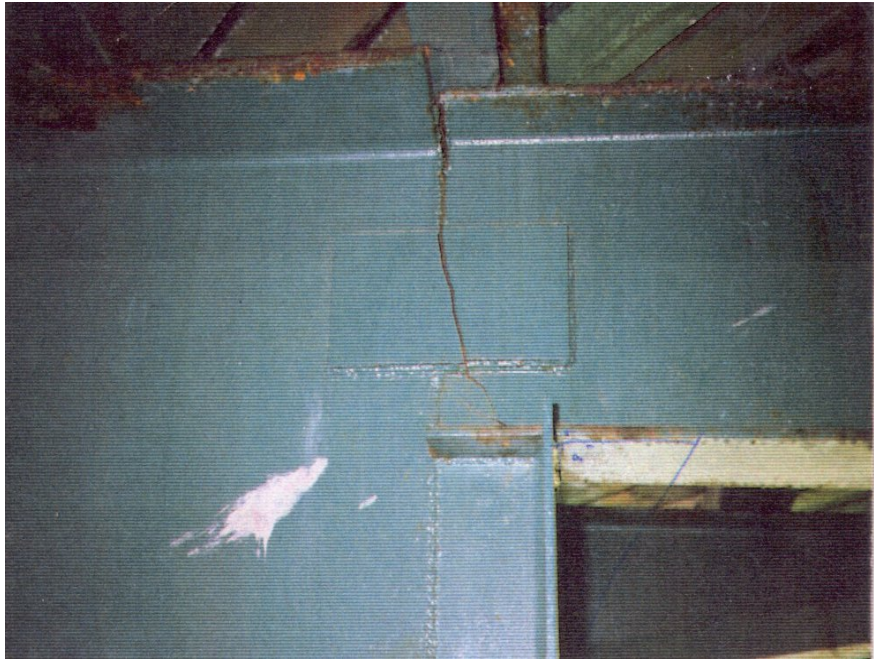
Fissuration d'une poutre en acier
